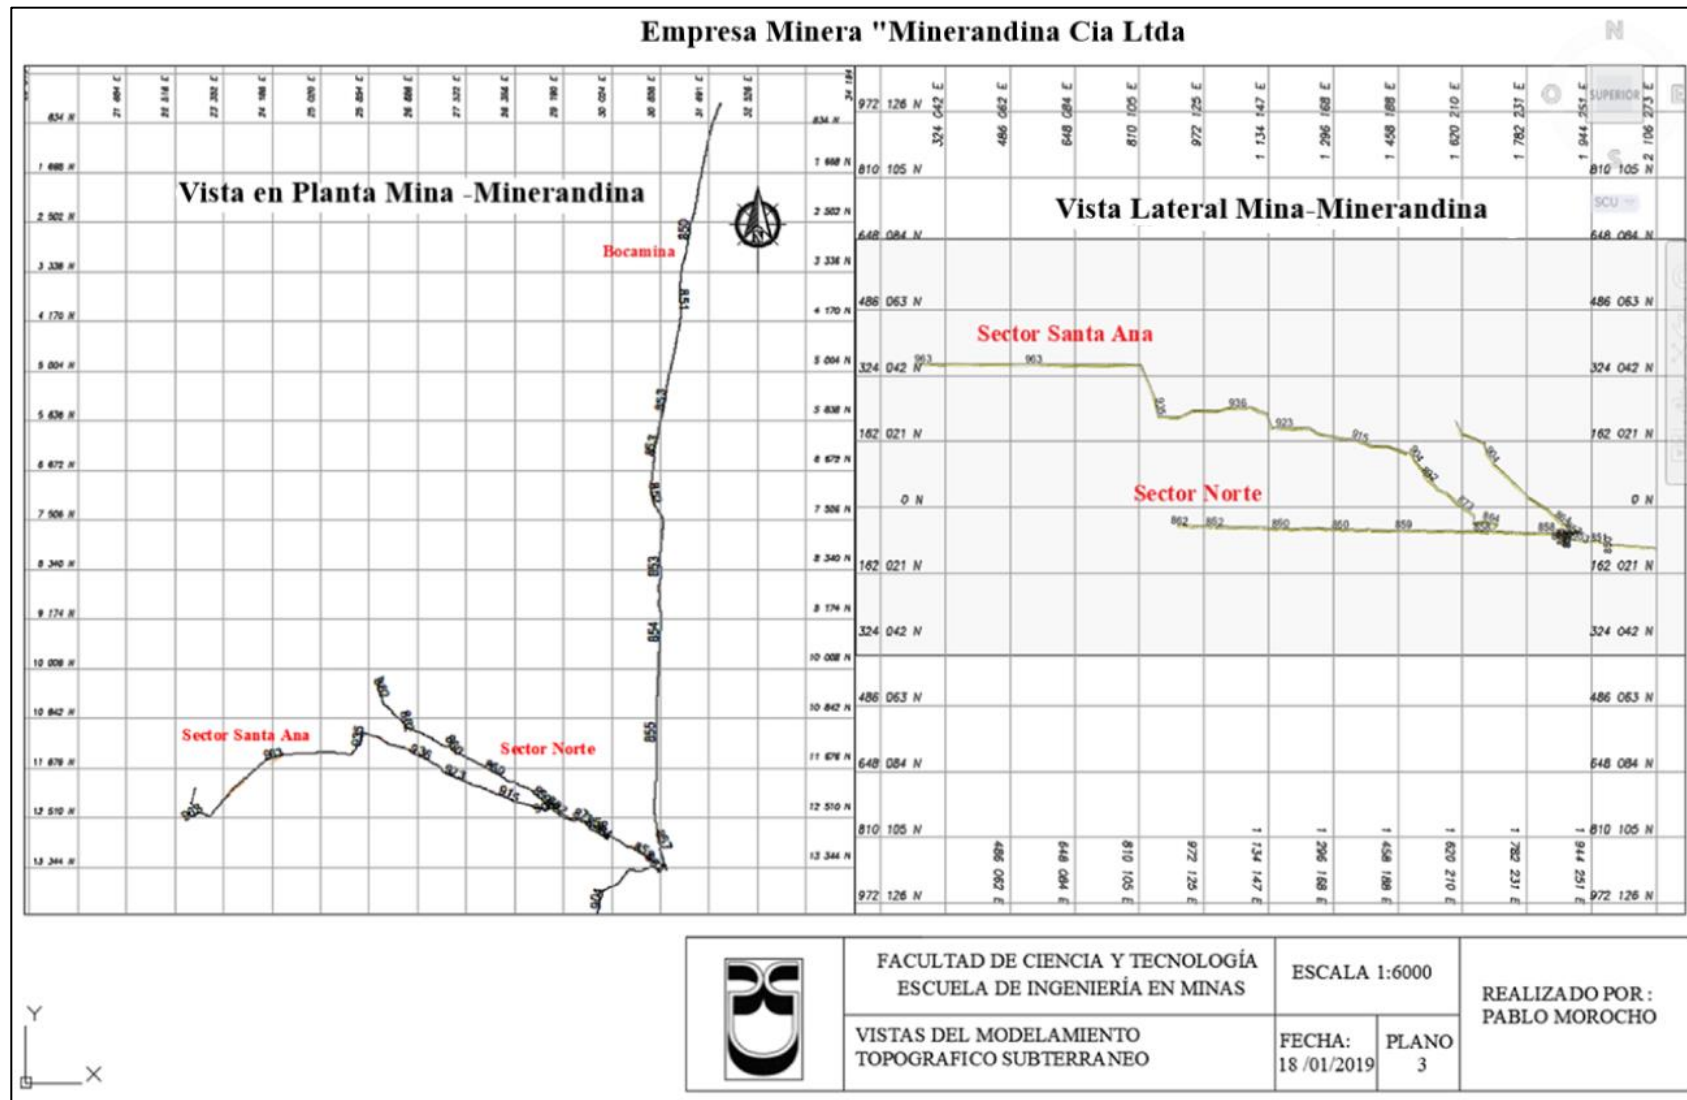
Vista en planta y lateral del levantamiento topográfico subterráneo
